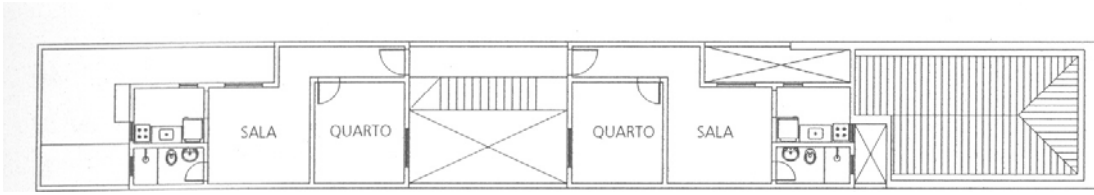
Rua do Livramento 147 – Planta baixa do segundo pavimento (SECRETARIA, 2000, p. 53).
